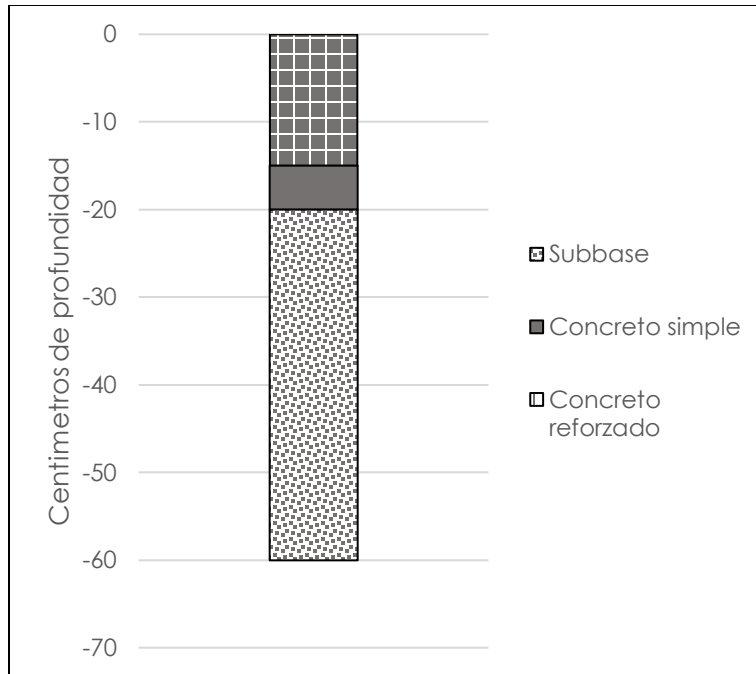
Corte de la estructura de pavimento para los tramos 3 y 4 el proyecto de San Vicente de Chucuri-Santander
